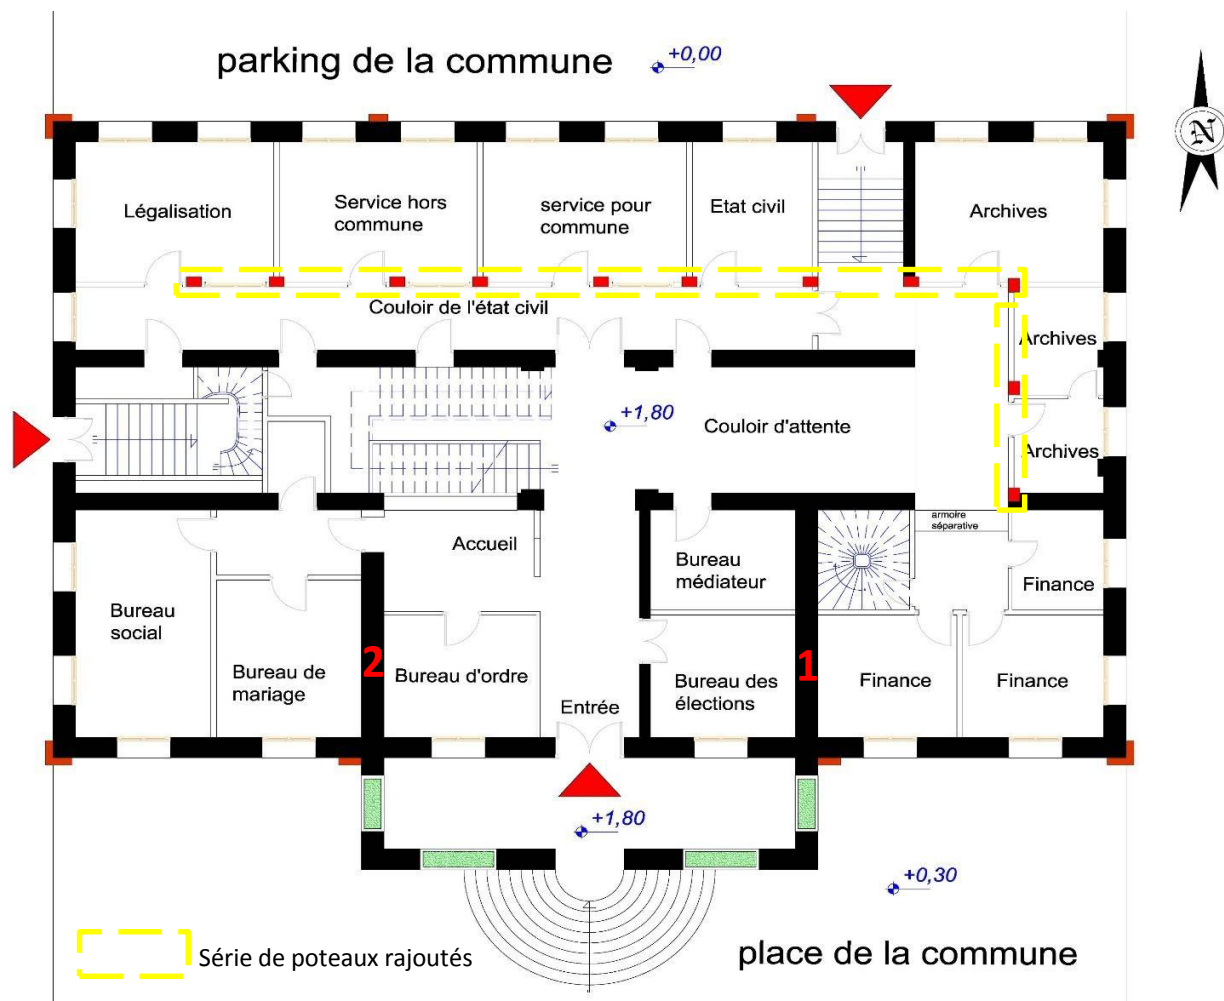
renforcement du plancher par une série de poteaux en béton armé
